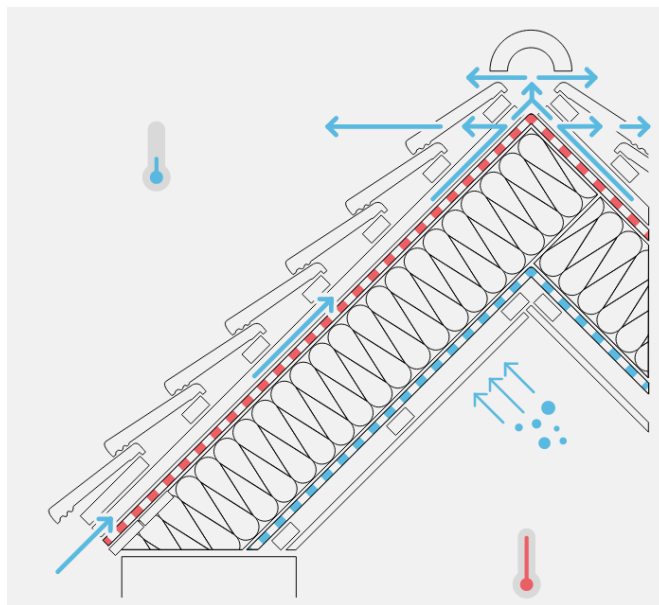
Конструкция с утеплением между стропил и вентилируемым подкровельным пространством.
